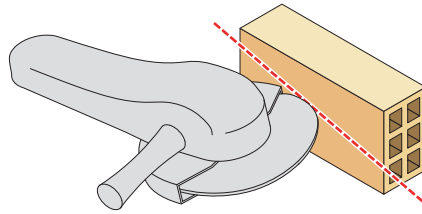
Aligeramiento del tabique en cubierta inclinada sobre forjado
